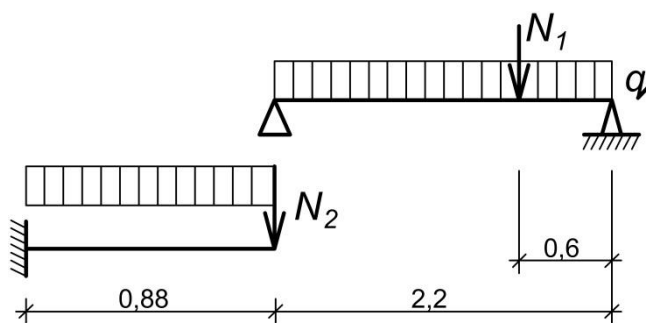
Расчет участка стены по схеме 1-1
